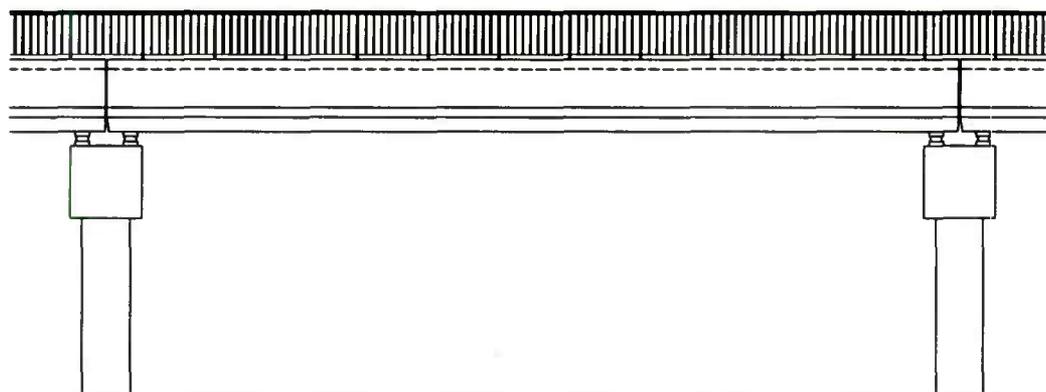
Dispositions en tête de pile pour des travées isostatiques.
